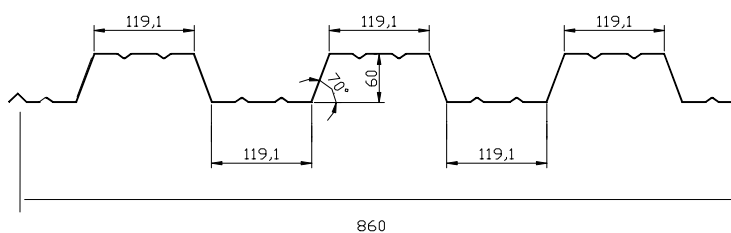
Seção transversal típica do perfil do Deck-60 (dimensões em mm)
